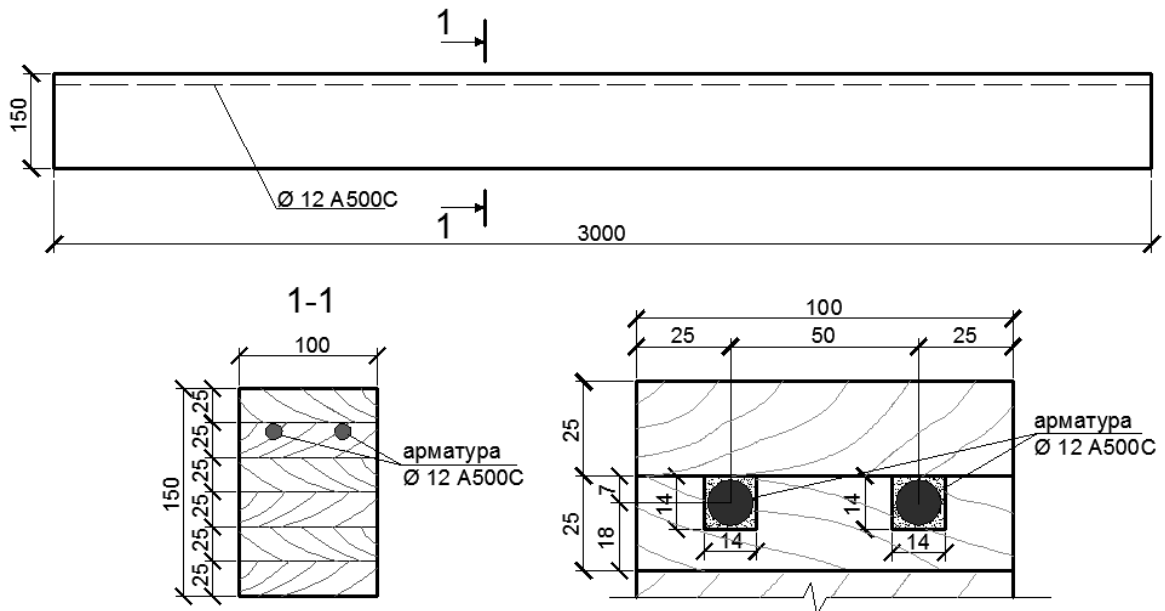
Схема армування балок другої серії сталеві арматурою
